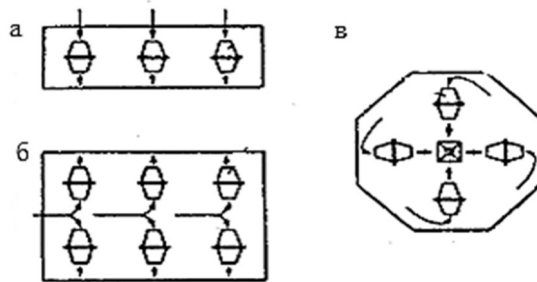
Схеми горизонтального компонування обладнання бетонозмішувальних установок: а – однорядне розміщення бетонозмішувачів; б – двохрядне; в – кушове
